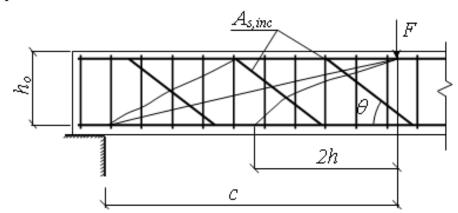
К определению наиболее опасной наклонной трещины для элементов с отгибами при расчете на действие поперечной силы
